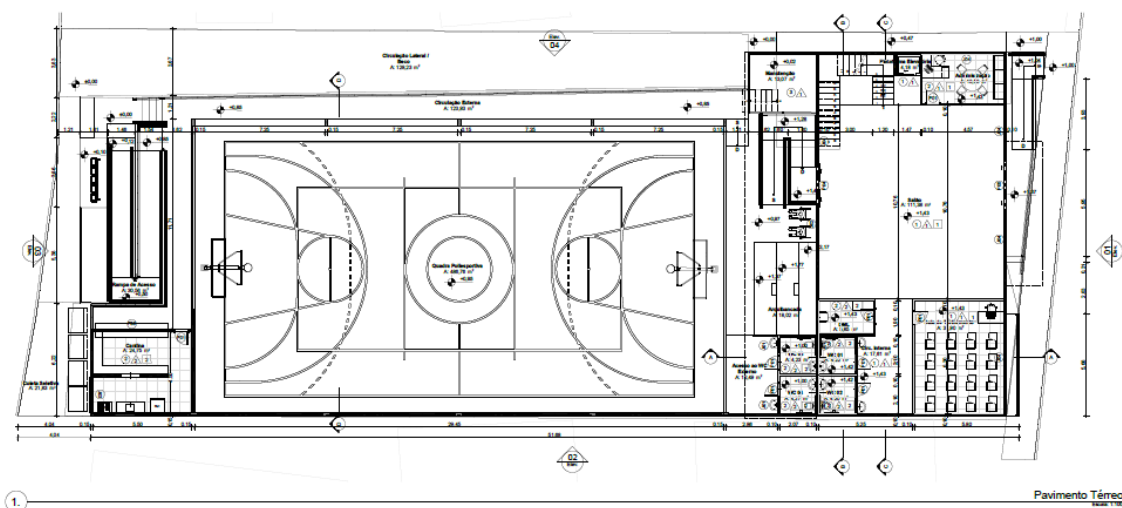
Implantação do Centro Social e Quadra poliesportiva – Pavimento Térreo.
